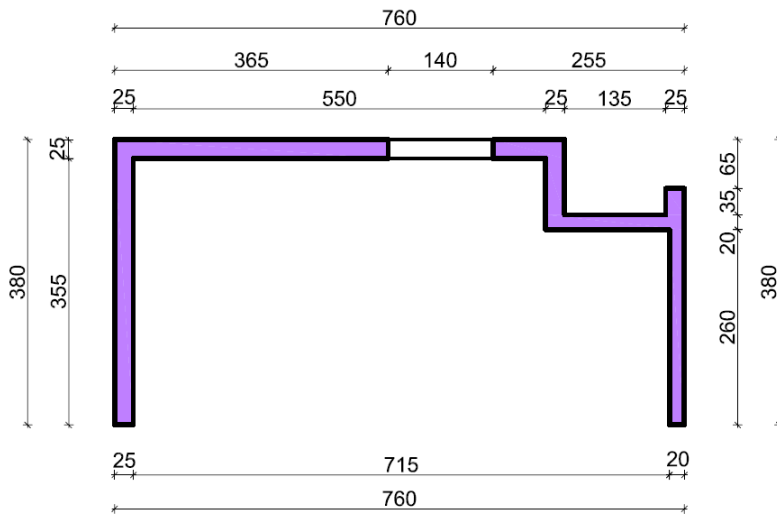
Grundriss - umlaufende Wand Nord
